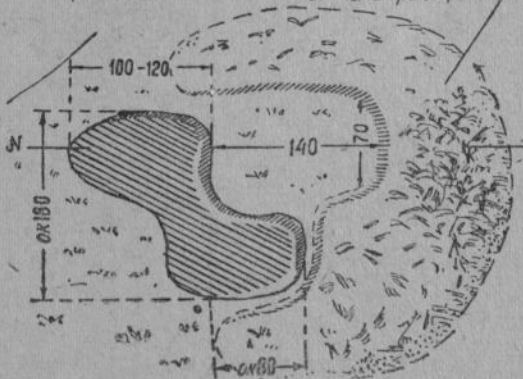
Пулеметная ячейка для стрельбы лежа из станкового пулемета.
